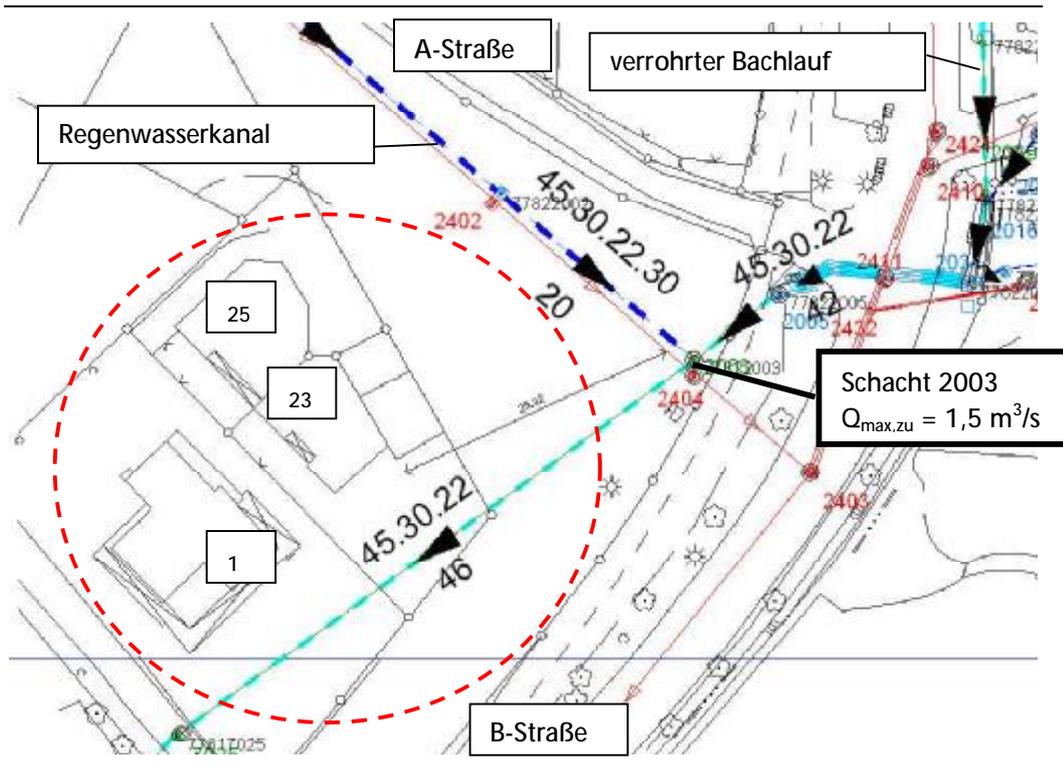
Lageplanausschnitt im Bereich eines Schadenswerpunkts
